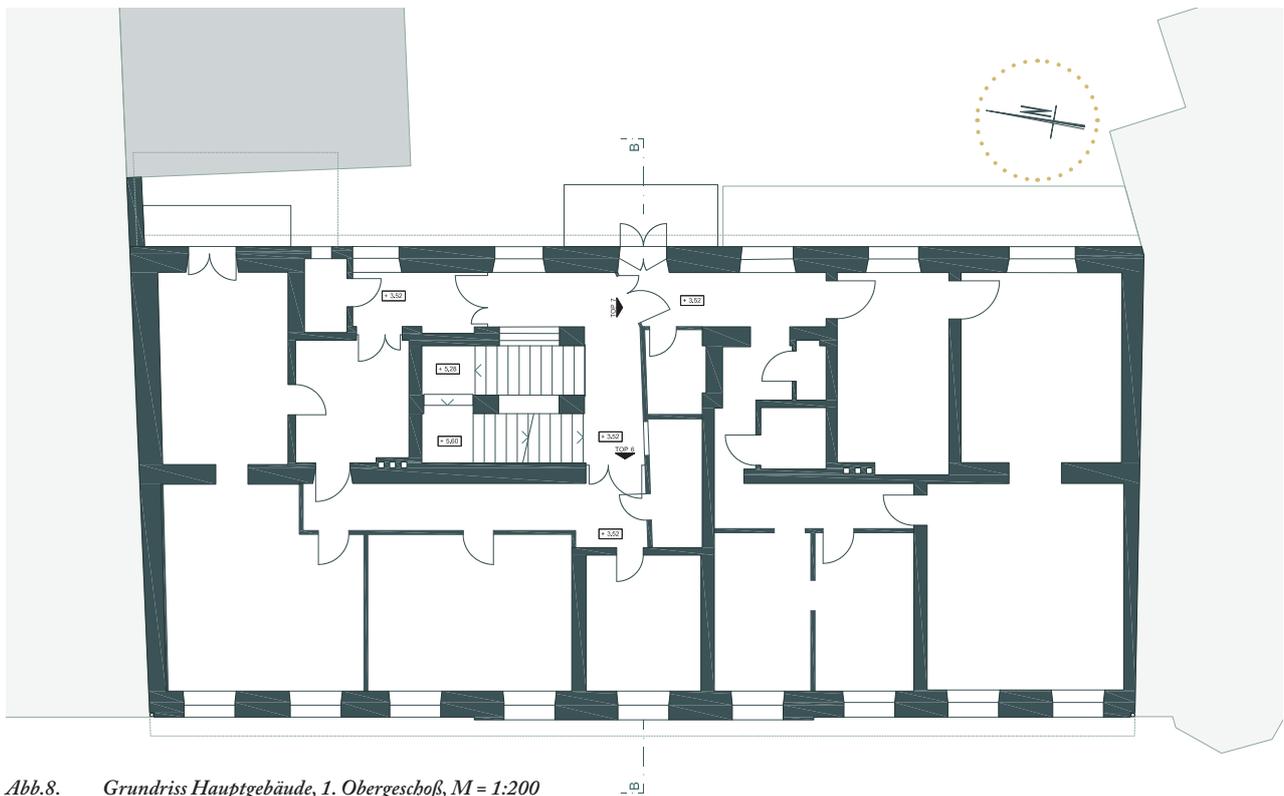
Grundriss Hauptgebäude, 1. Obergeschoß, M = 1:200
